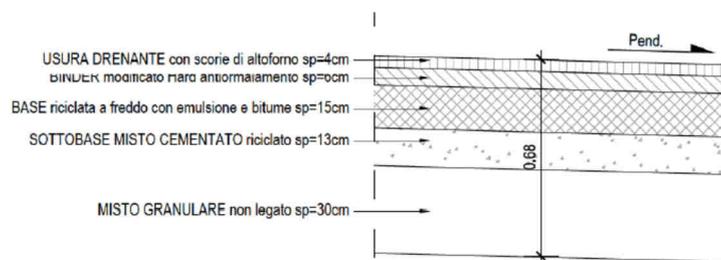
dettaglio sovrastruttura stradale per SS 554 ed SS 131
